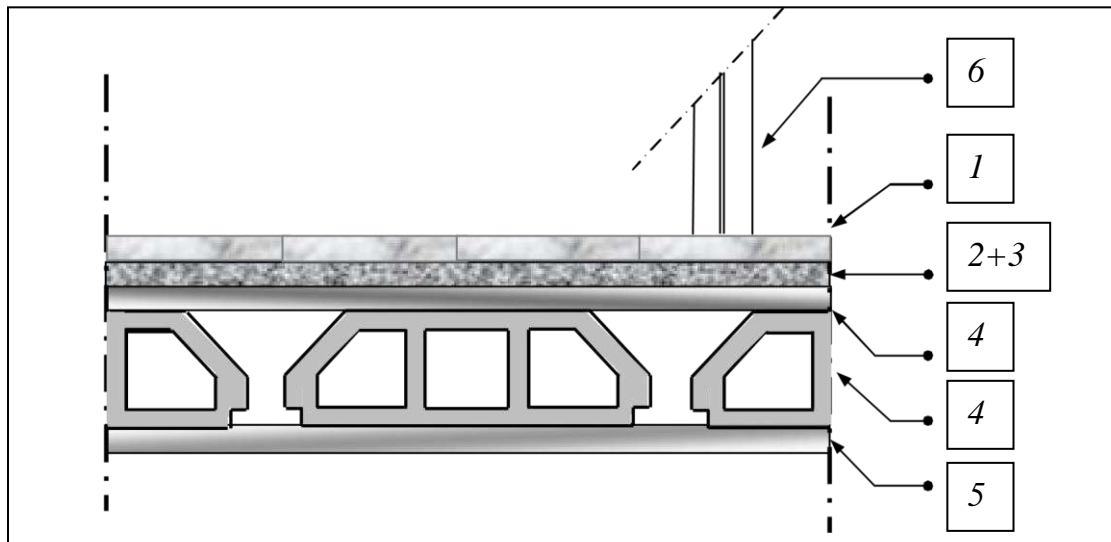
Coupe plancher étage courant Charge permanente :
